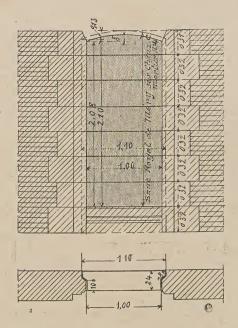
Plan et élévation sur le bouchement de baie au 3° étage.
